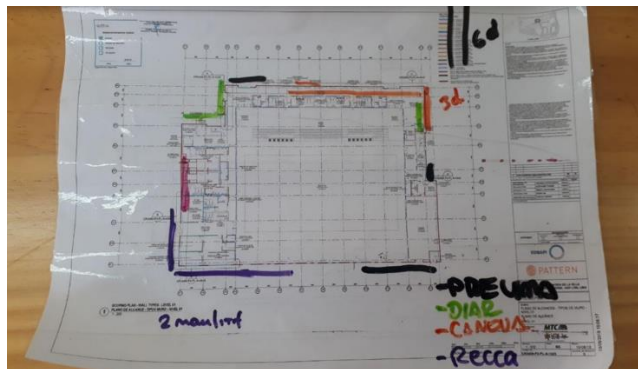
Planificación diaria para la fachada. Fuente: Archivos del autor.
